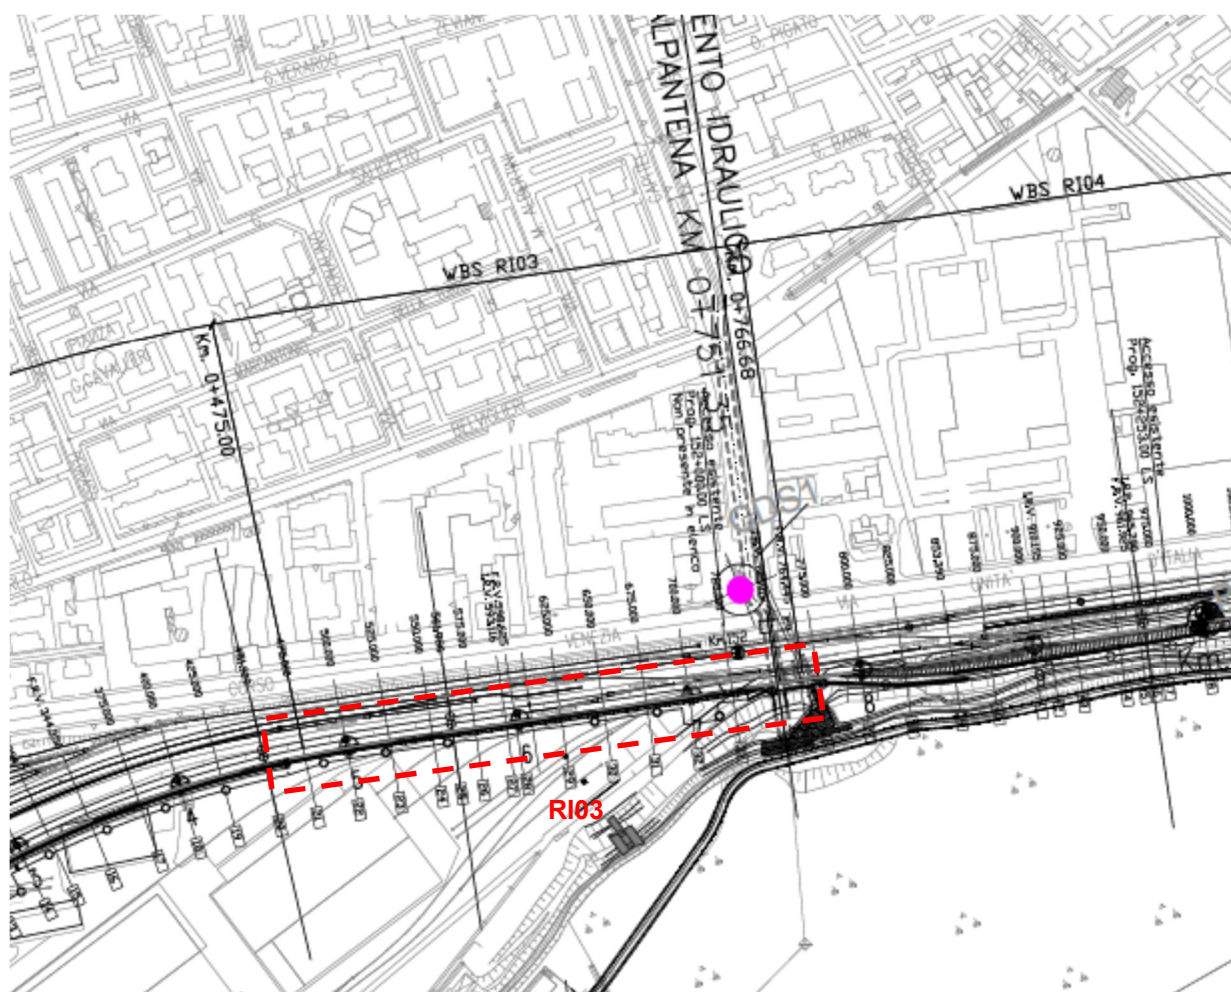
Planimetria Rilevato R103, estratto dalla Planimetria Generale (Doc. Rif. [3])
